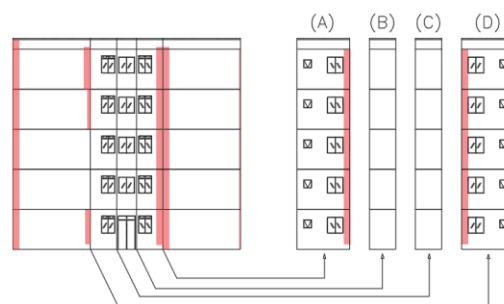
Fachada nordeste e sudoeste do Edifício E30
